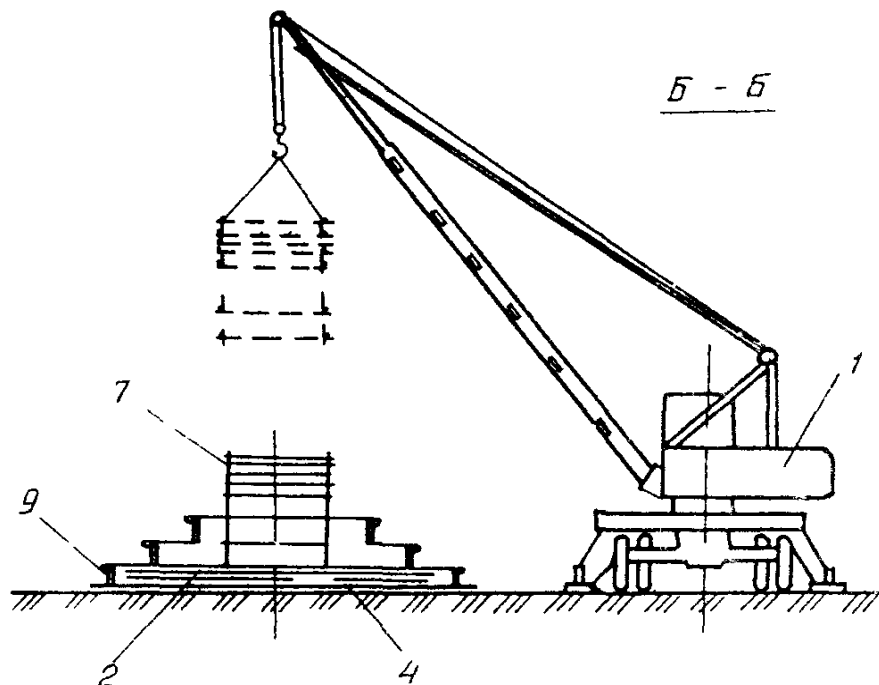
(Разрез Б-Б). Схема монтажа арматурных каркасов
